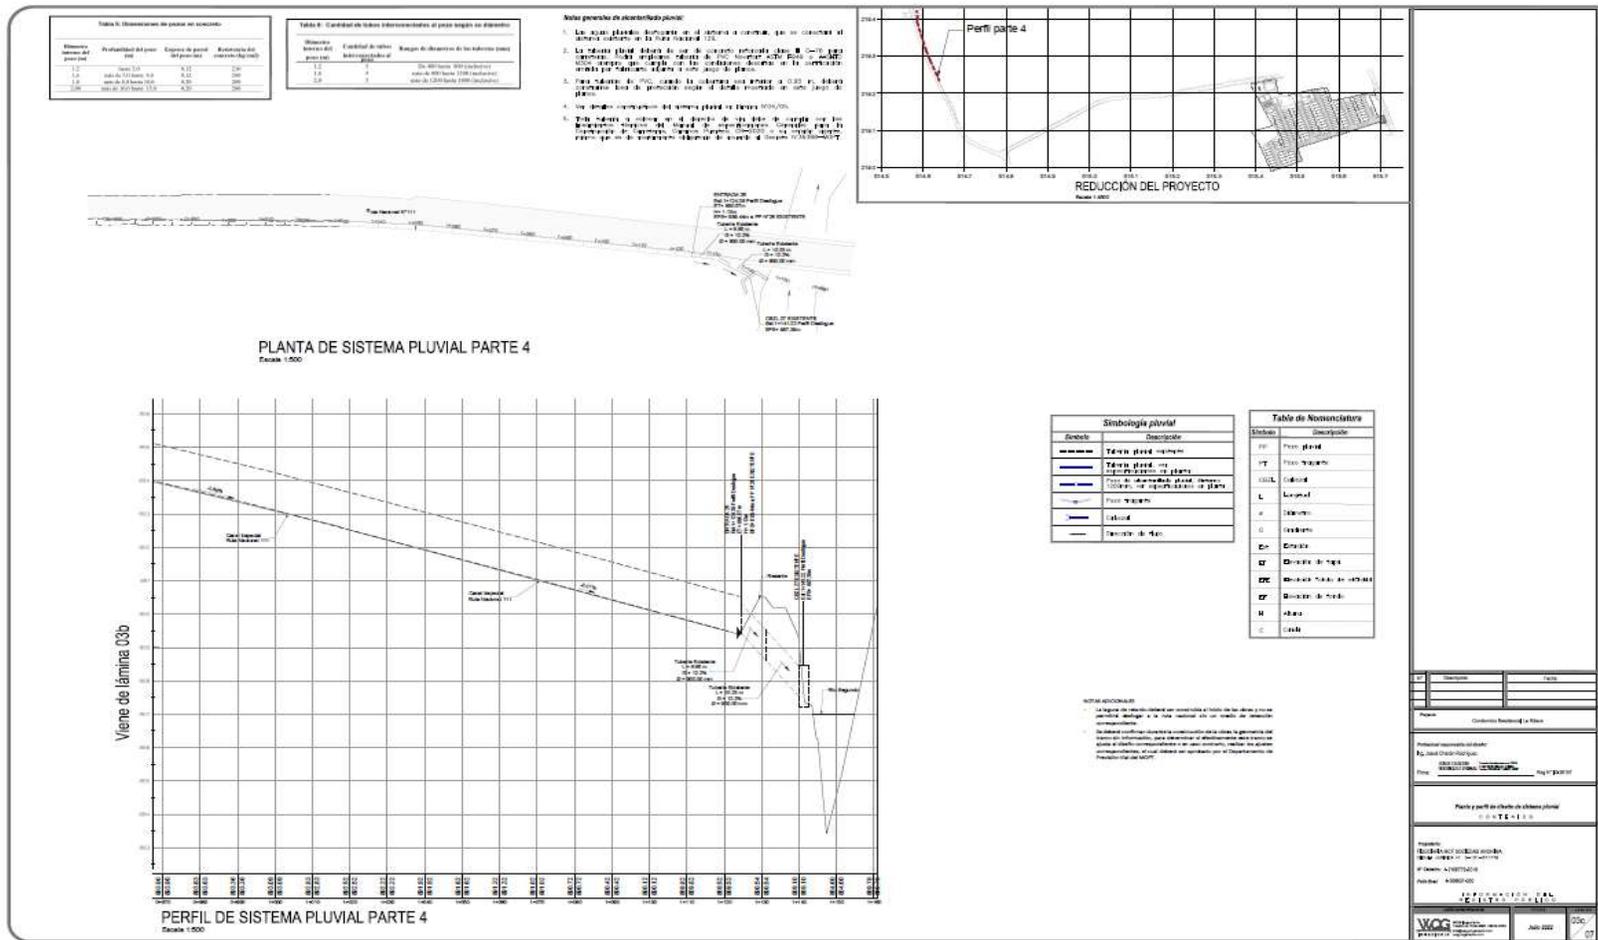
Trayecto de Tubería Pluvial sobre Ruta Nacional # 129, descarga en Río Segundo. (trayecto # IV). Lámina Pluvial # 03d
